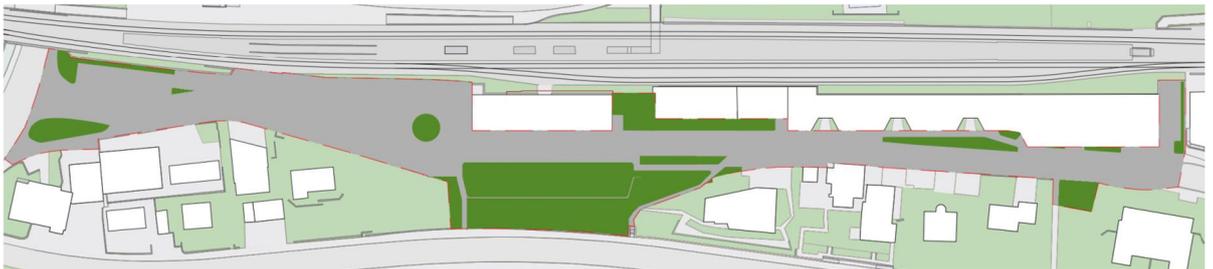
Planausschnitt der begrüneten Stützmauern SBB mit Rankgerüst.
